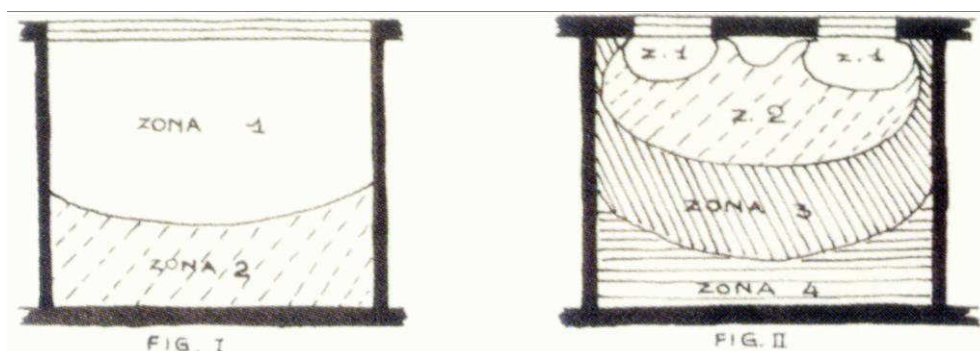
CROQUI COM ESQUEMA DE JANELAS E VENTILAÇÃO
